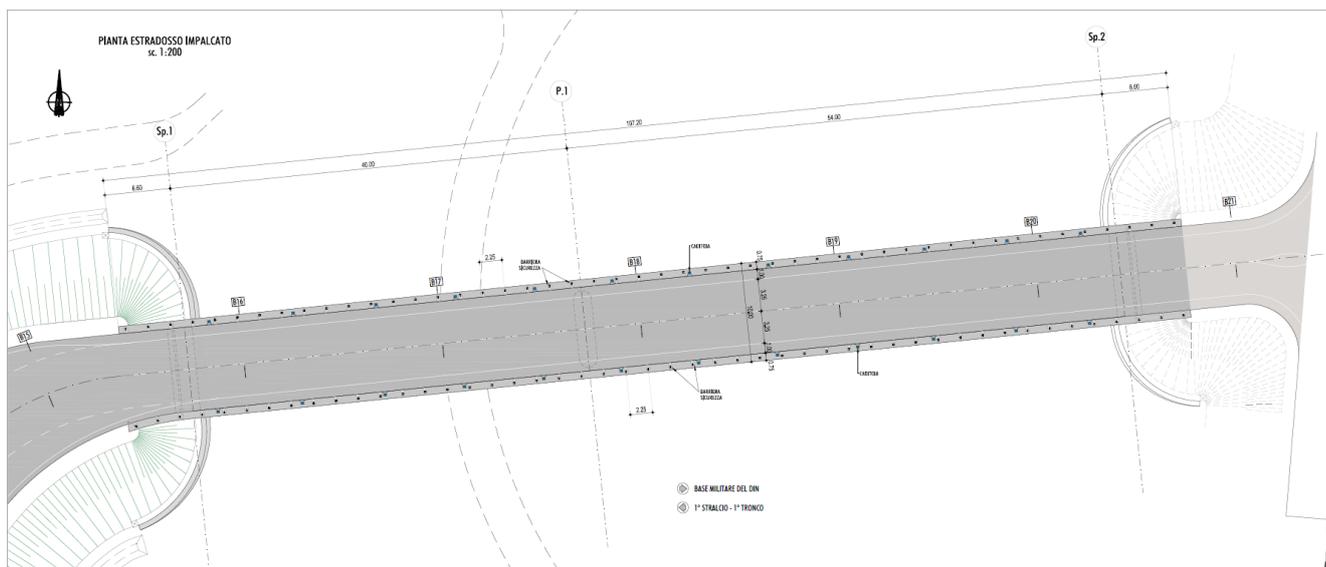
VISTA IN PIANTA DEL PONTE – LIVELLO IMPALCATO
